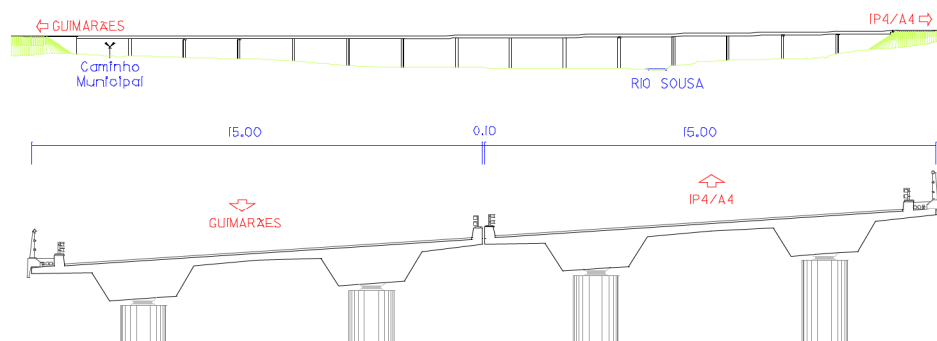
Alçado e corte transversal da Ponte sobre o Rio Sousa
